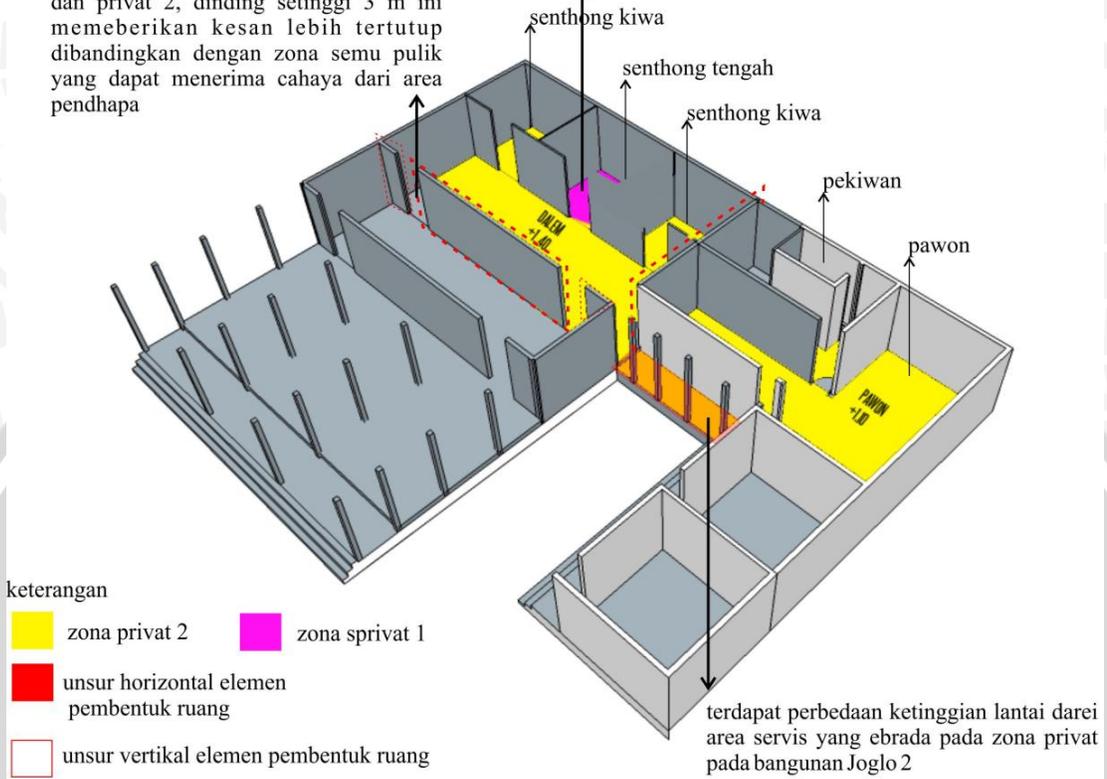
Elemen pembentuk ruang pada zona semi publik studi kasus J2
